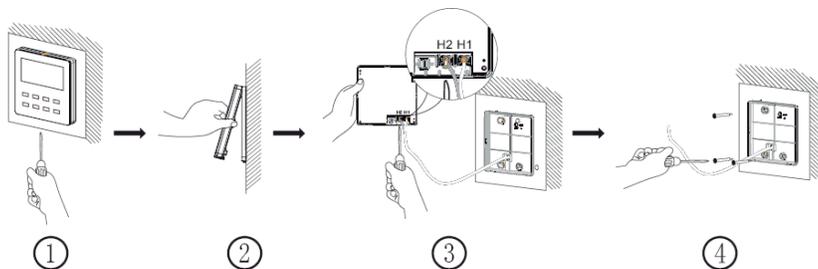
Diagrama de desmontaje del controlador por cable
